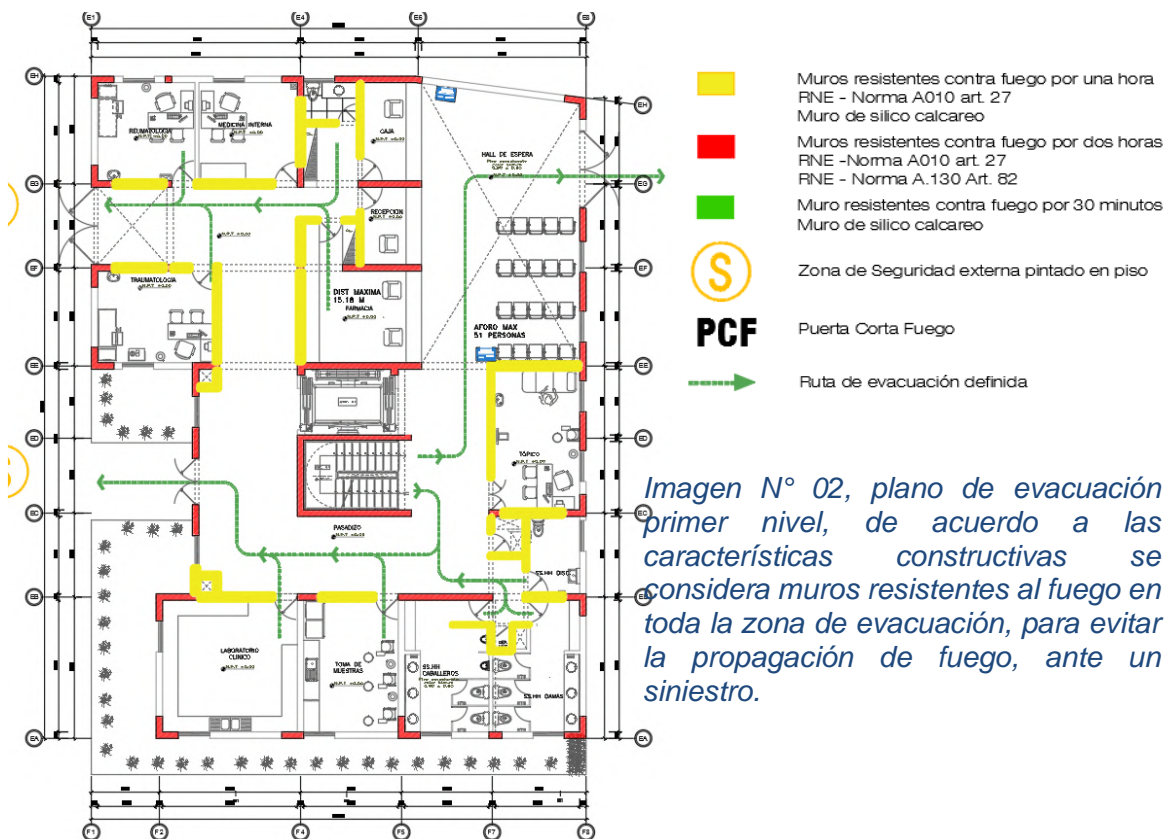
Plano general, sectorización de zonas seguras de evacuación.
